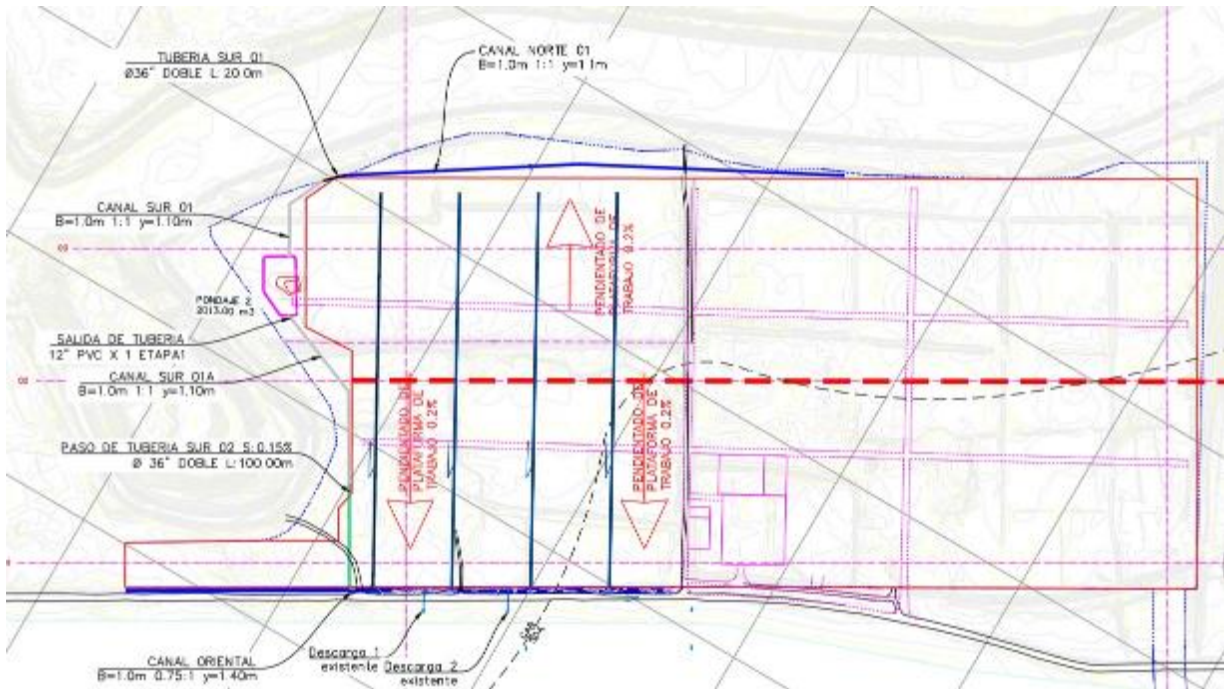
Localización de obras de drenaje en la plataforma en la etapa de construcción
